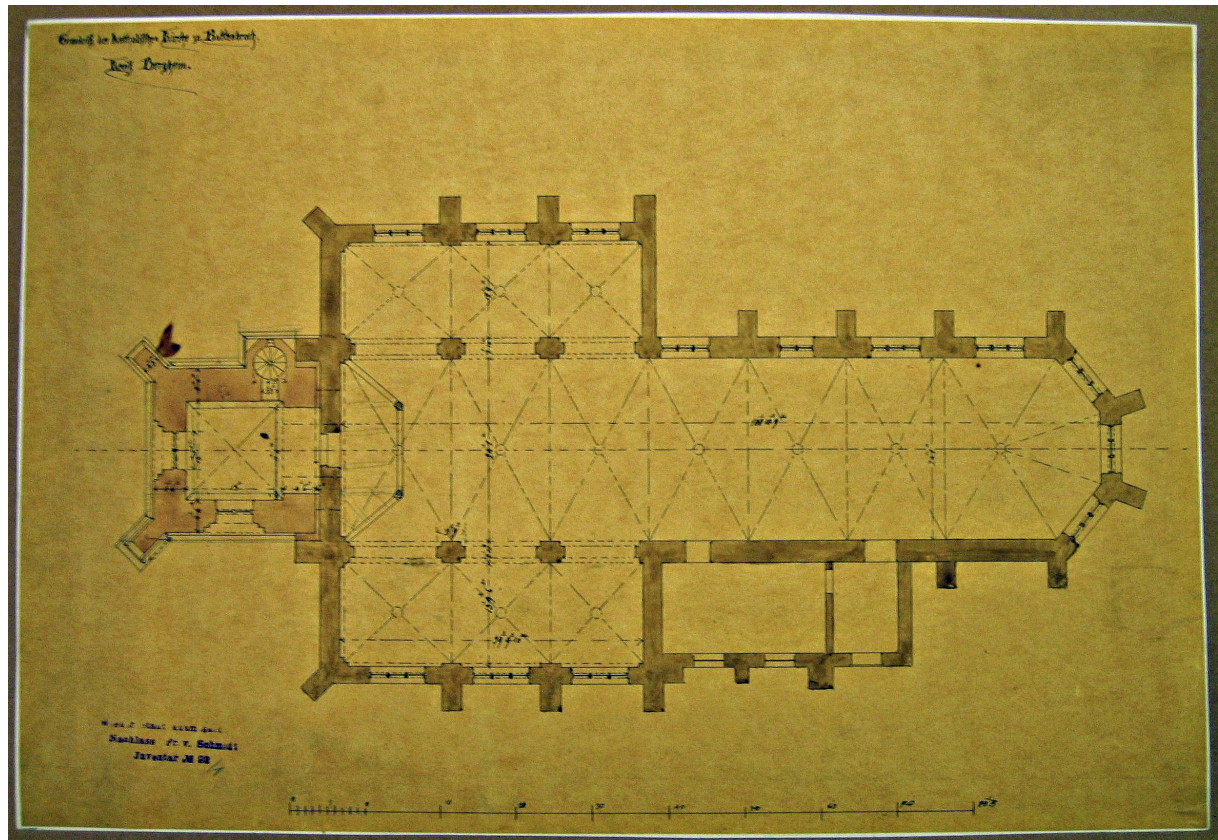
WM, Inv.-Nr. 157.92/1 Grundriss, Pause
